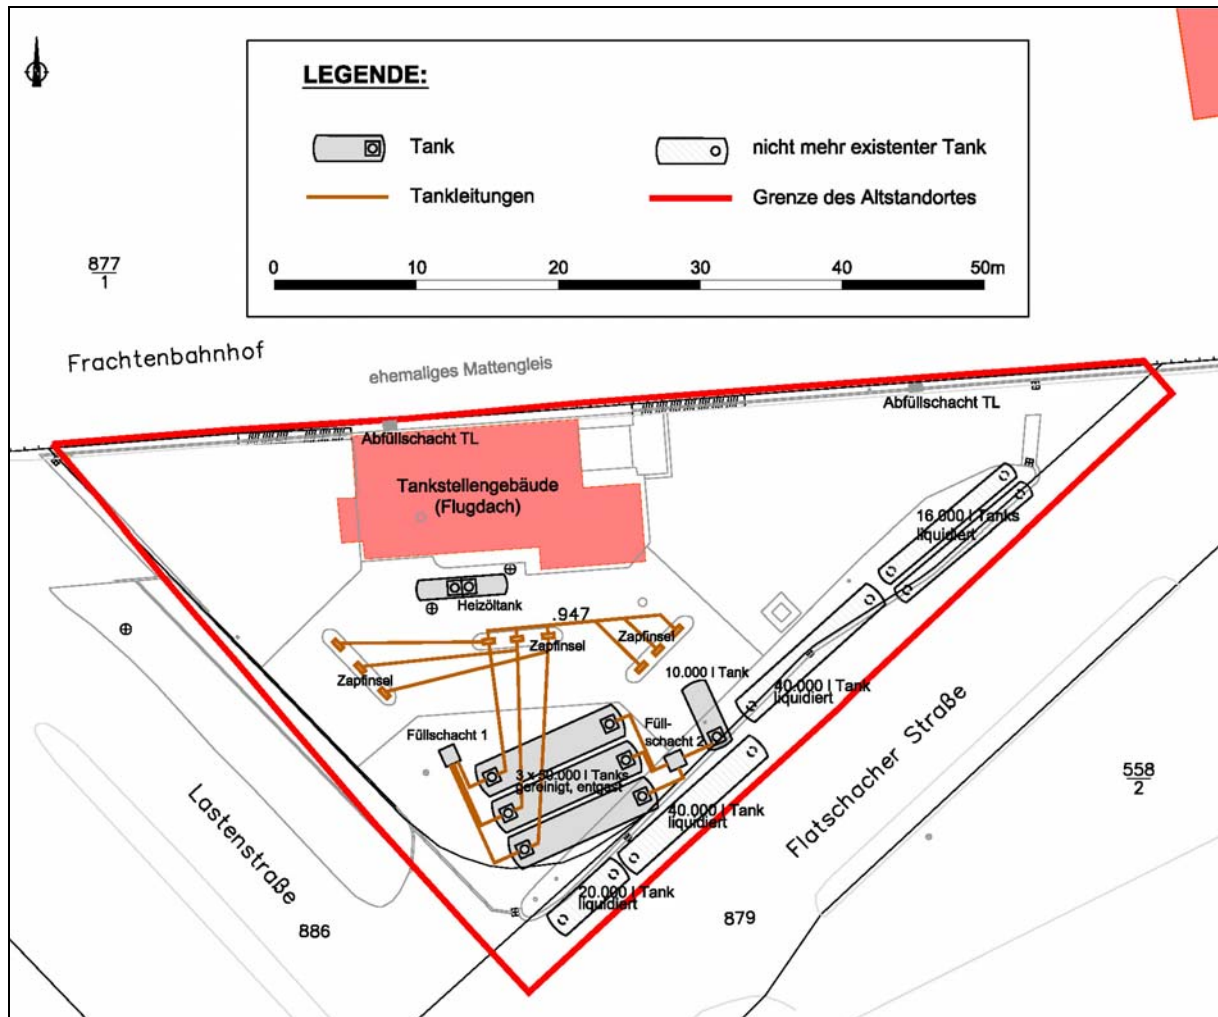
Lageplan der tankstellenspezifischen Einbauten und Gebäude
